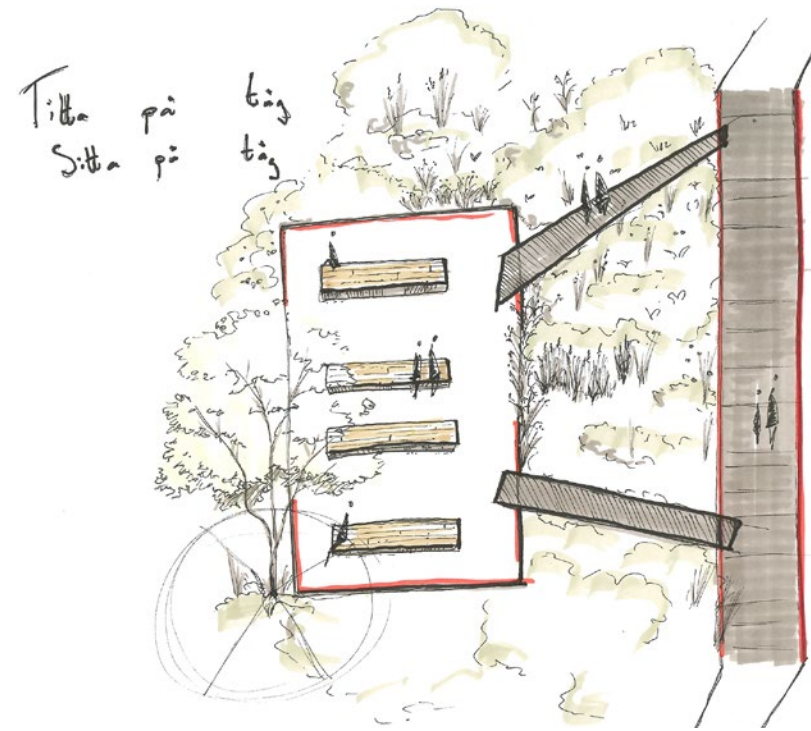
Planskiss för ett frilagt parkrum. Hur stor yta skulle det ta i anspråk?
